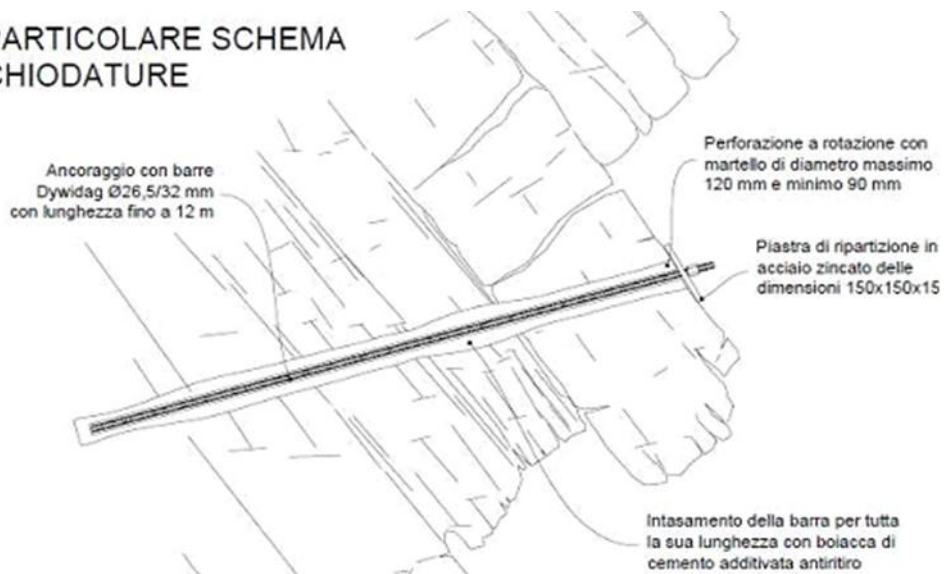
Particolare chiodatura sub orizzontale con riempimento a gravità (dalle tavole di progetto – 1)
